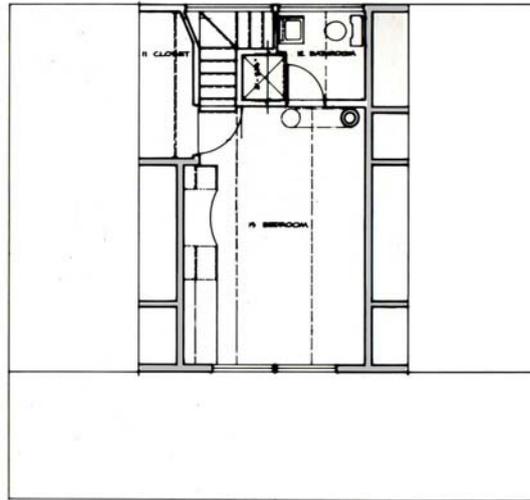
Planta baixa. Segundo pavimento.
